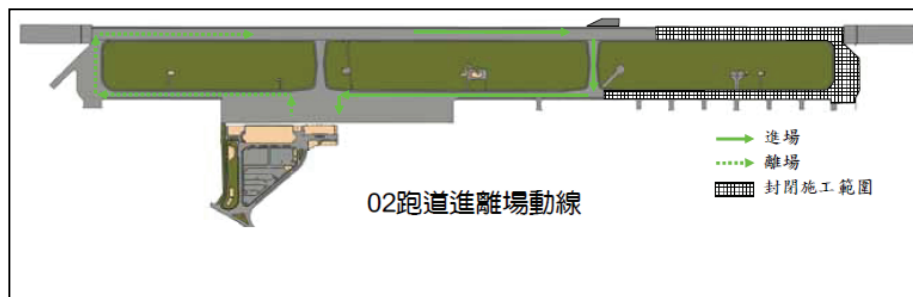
第 2 施工階段 02 跑道進離場動線及封閉施工區圖
